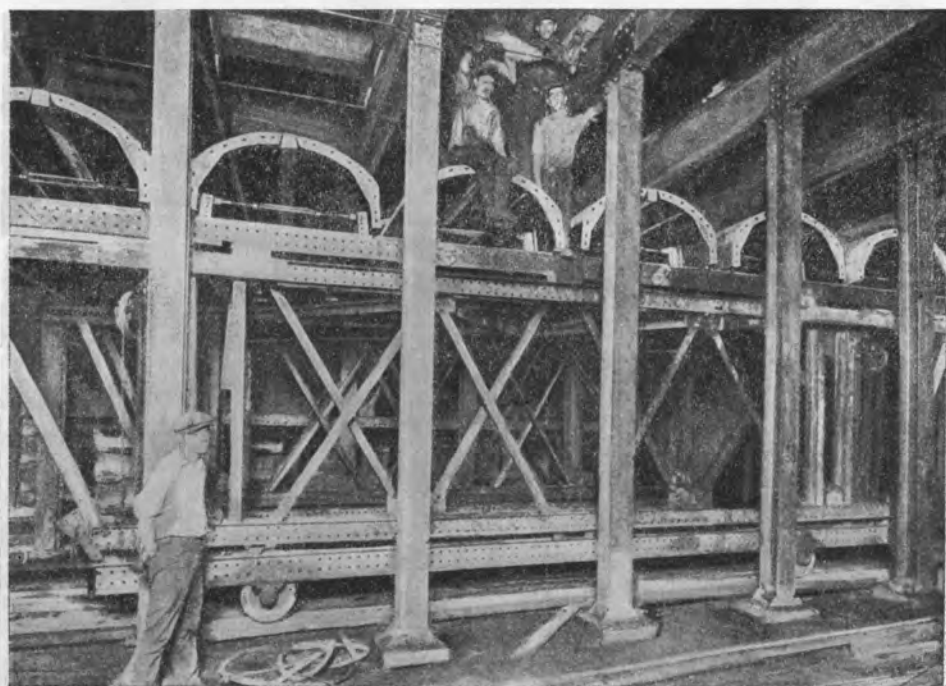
Подвижная металлическая опалубка перекрытий системы Блоу Нокс.
